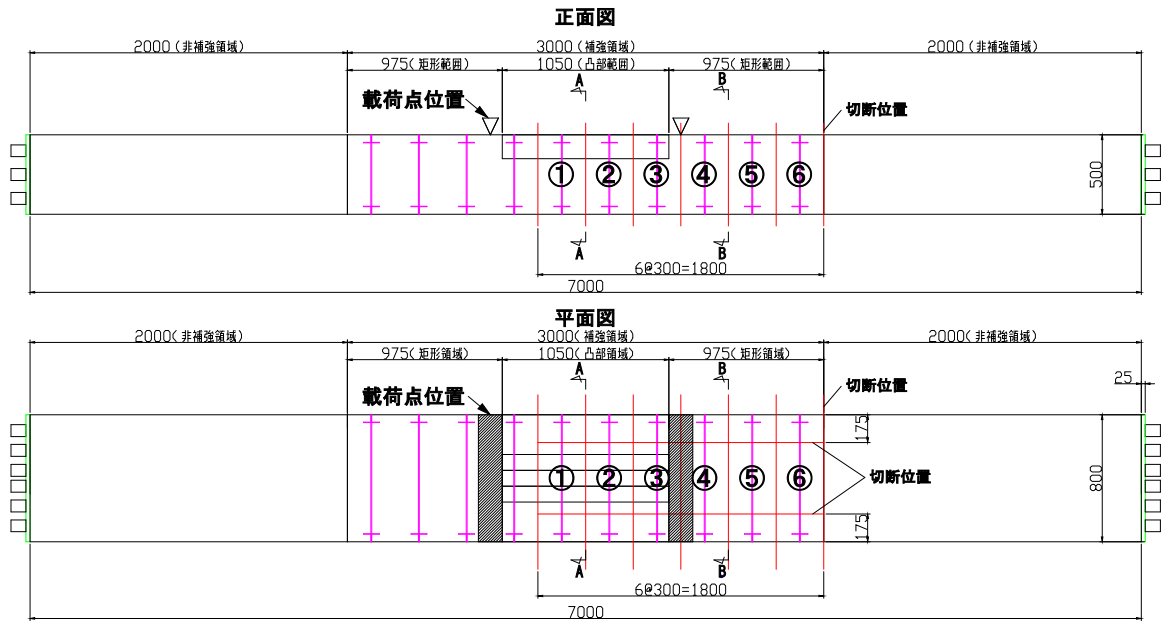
3. 4 ひび割れ誘発目地の構造
